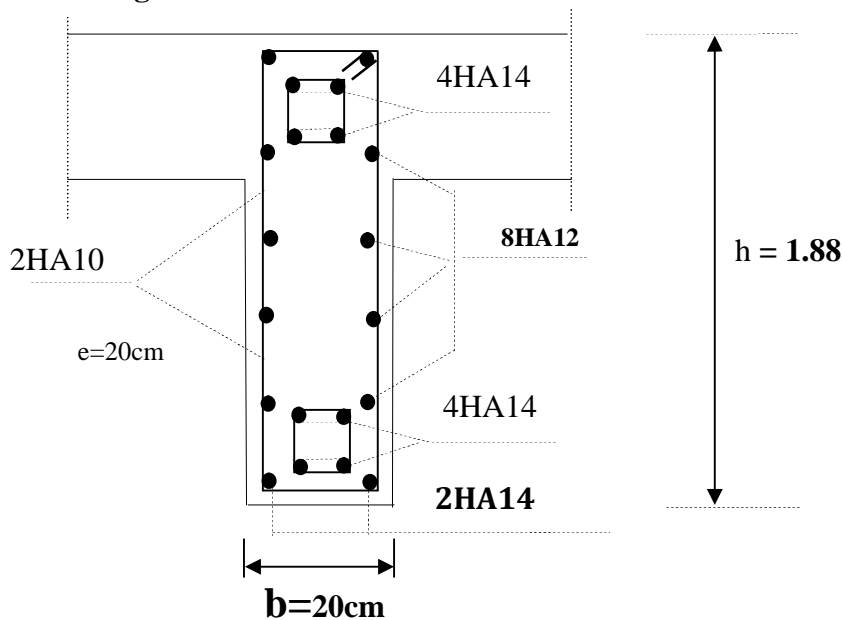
Plan de ferraillage des linteaux : Zone I
